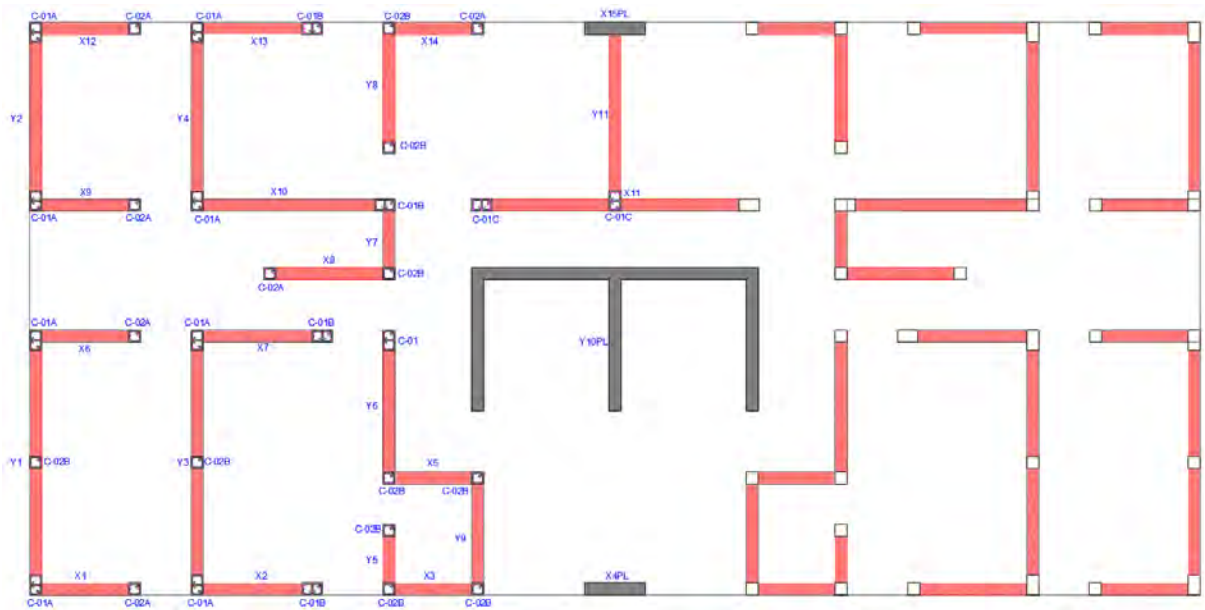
Planta de distribución de columnas, placas y muros.
